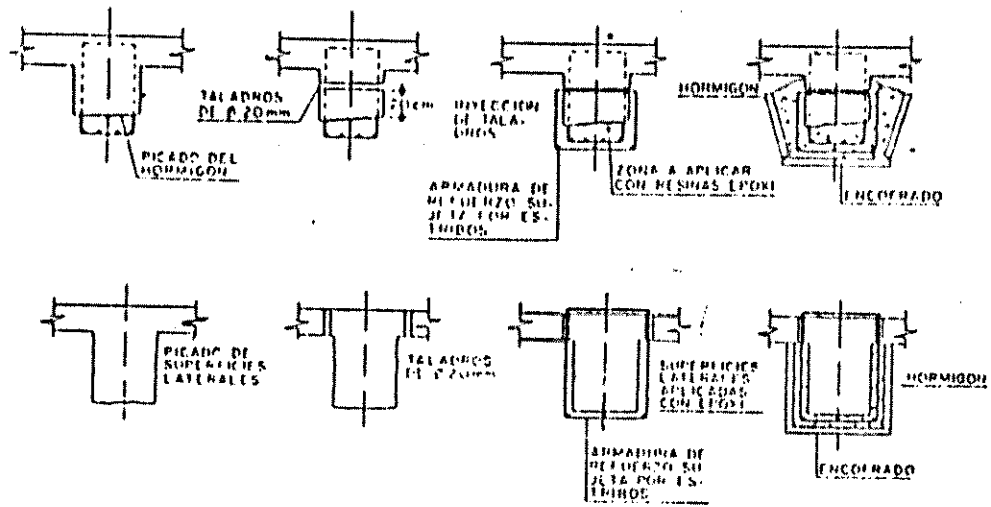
Refuerzo de una viga mediante nueva armadura cosida a la misma, o una armadura cosida cosida al forjado.
